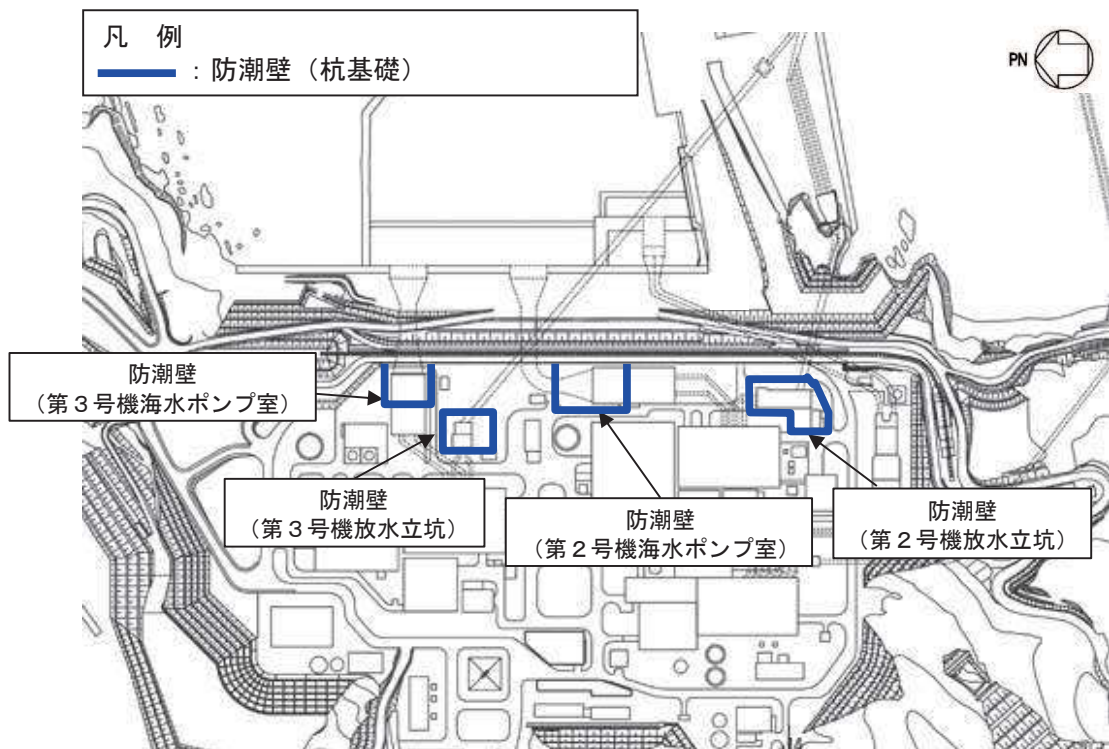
防潮壁（杭基礎）の平面配置図
